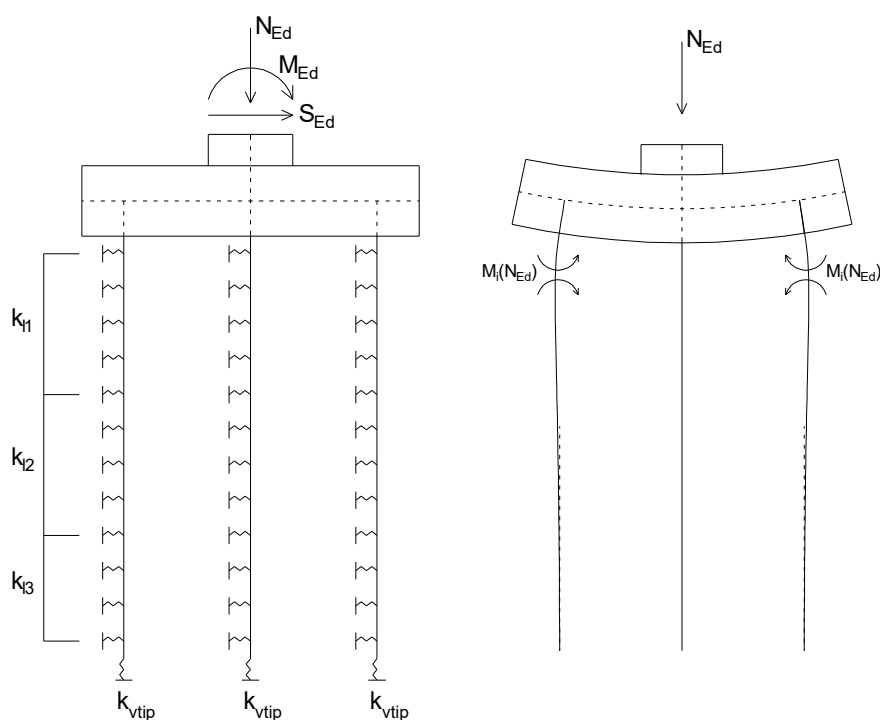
Modello del plinto su pali ed effetto flessionale su pali dovuto al carico assiale agente sul plinto (a destra)
